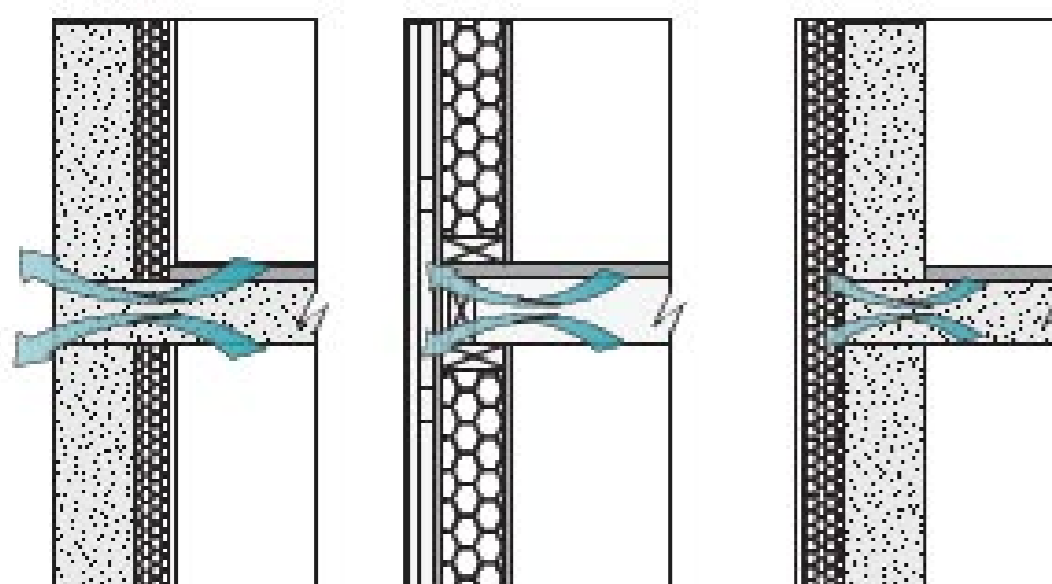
Comportamiento de los puentes térmicos en encuentros de piso y muro según la posición del aislante: Aislación interior: puente térmico significativo. Muro panel de madera: puente térmico débil. Aislación térmica exterior: puente térmico despreciable (elaborado por autores).
